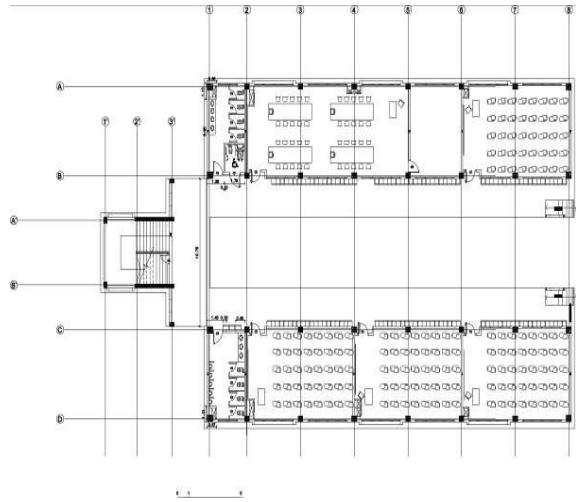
Planta Baja del aula, UEM Manta. Fuente: MINEDUC. Dibujo: Autor, 2020.
